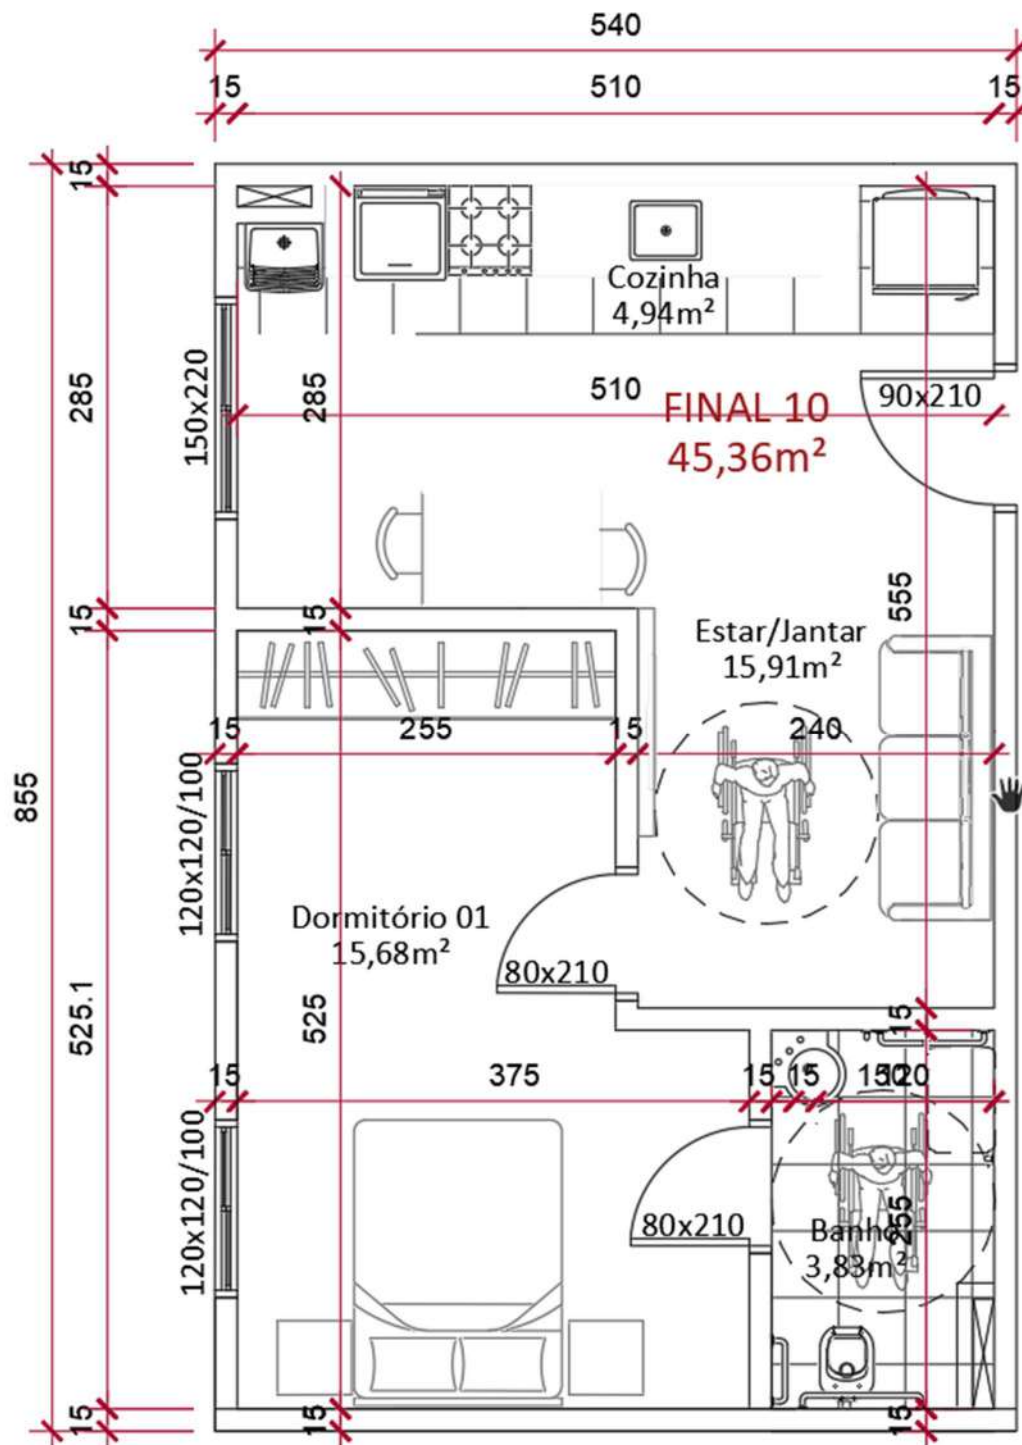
Planta Baixa apartamentos adaptáveis para PNE's. Aptos 901, 904, 905 e 906
